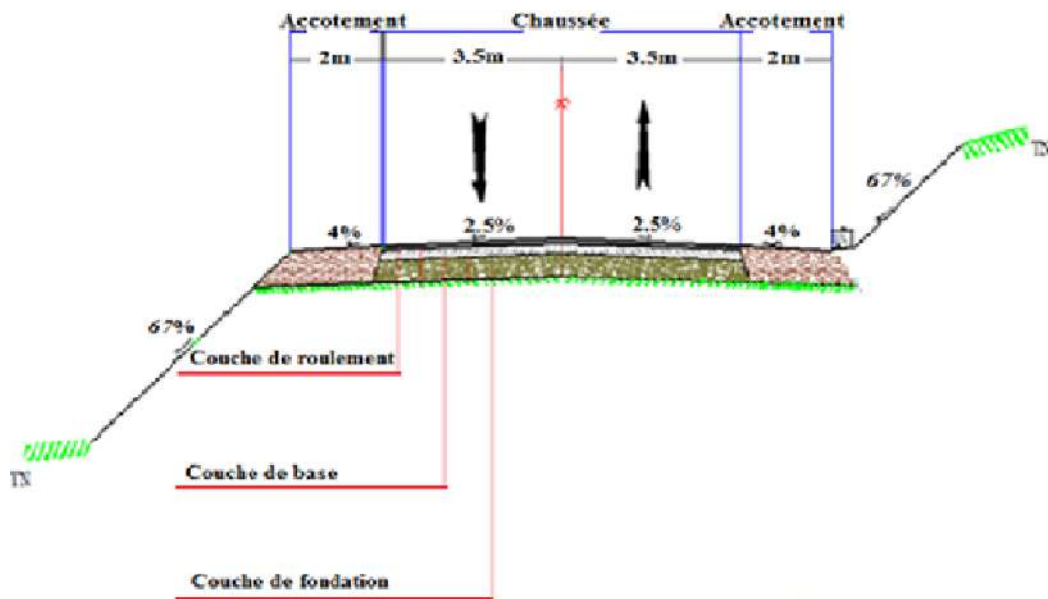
Types De Profils En Travers (Cas Mixte) [19]
